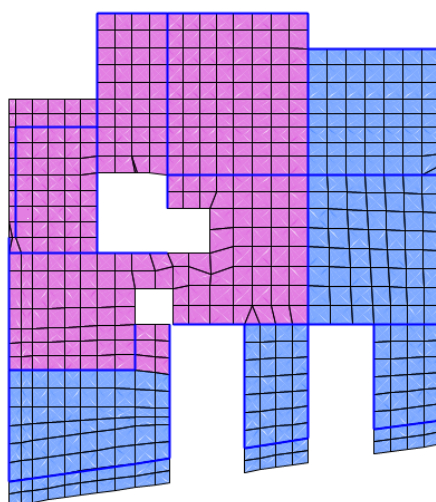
Sobrecargas do piso (roxo) e das coberturas (azul) do segundo piso.
